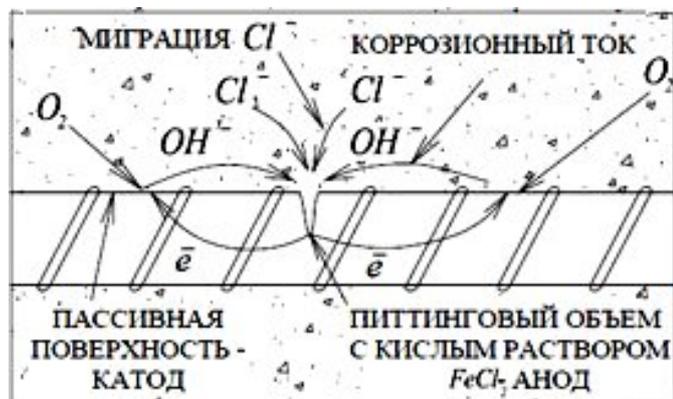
Схема электрохимической коррозии стальной арматуры в железобетоне
